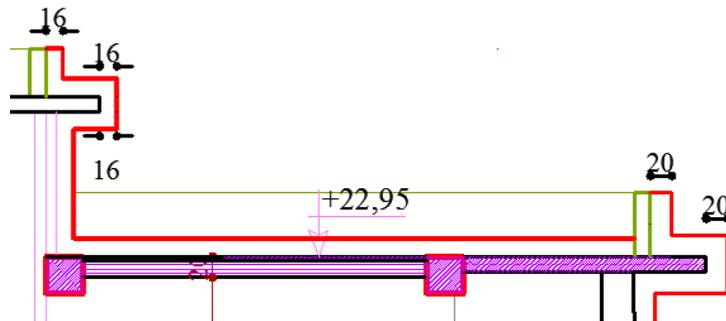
détail de raccordement mur-toiture (source détail dans la coupe modifier par l'auteur)
